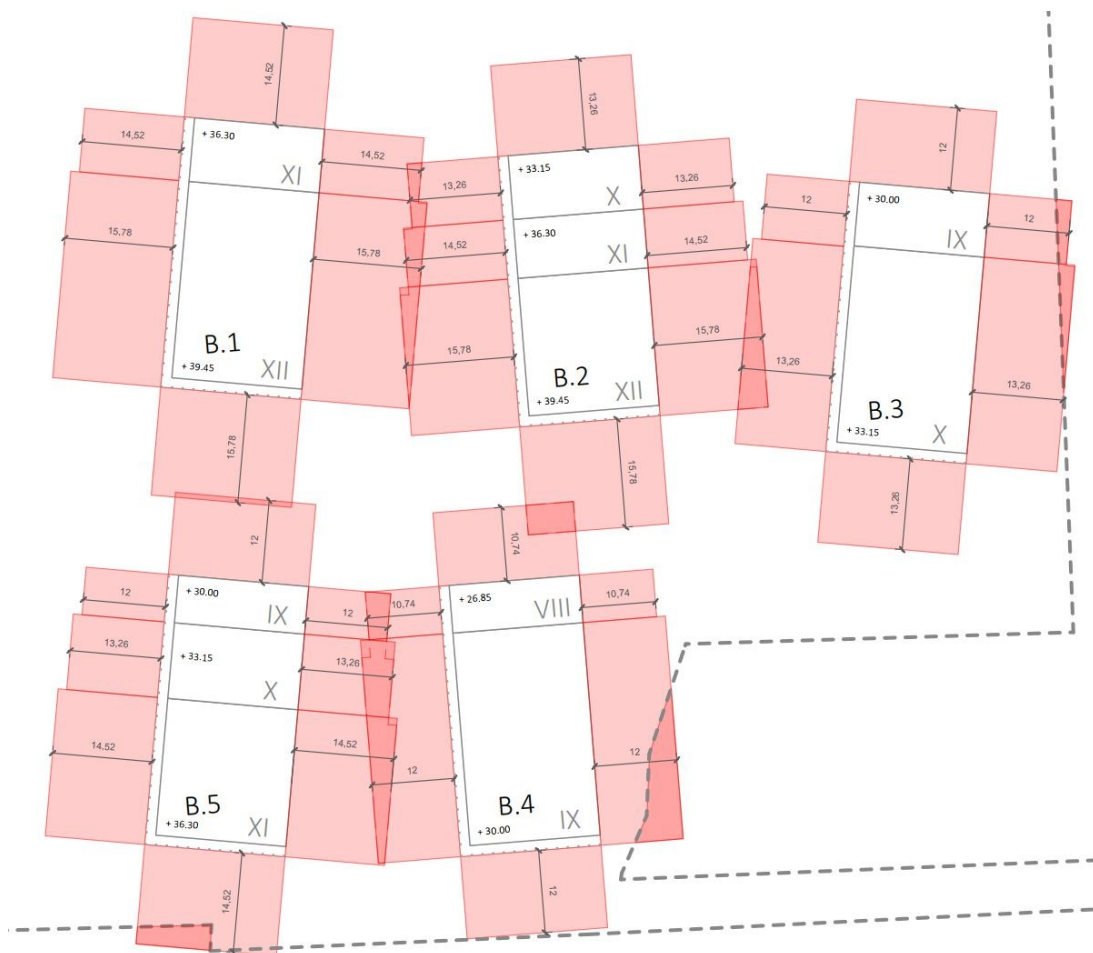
Ausschnitt aus dem Abstandsflächenplan mit der Gebäudegruppe B (Haus B.1 bis B.5)
